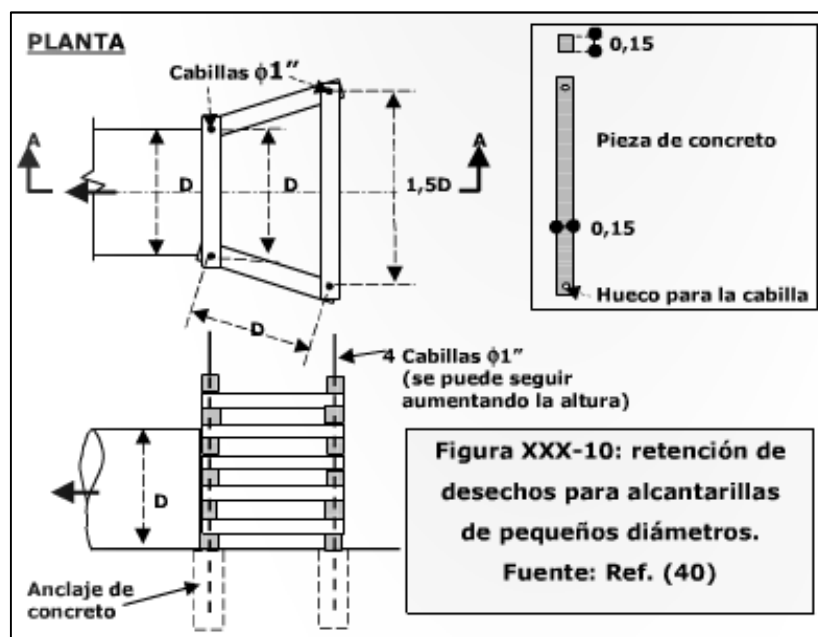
RETENCIÓN DE DESECHOS PARA ALCANTARILLAS DE PEQUEÑOS DIÁMETROS
